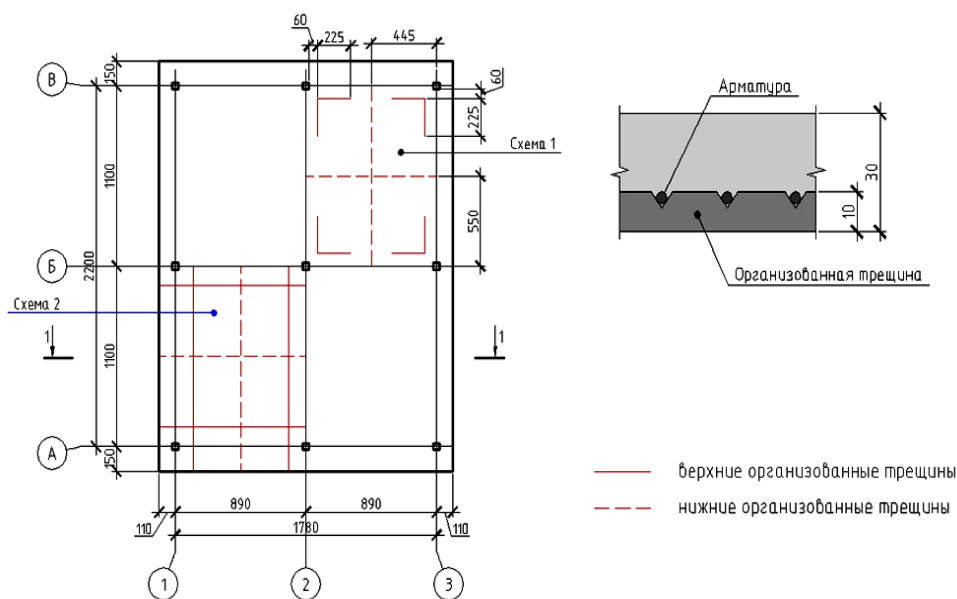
Схемы расположения заранее организованных трещин в перекрытии
